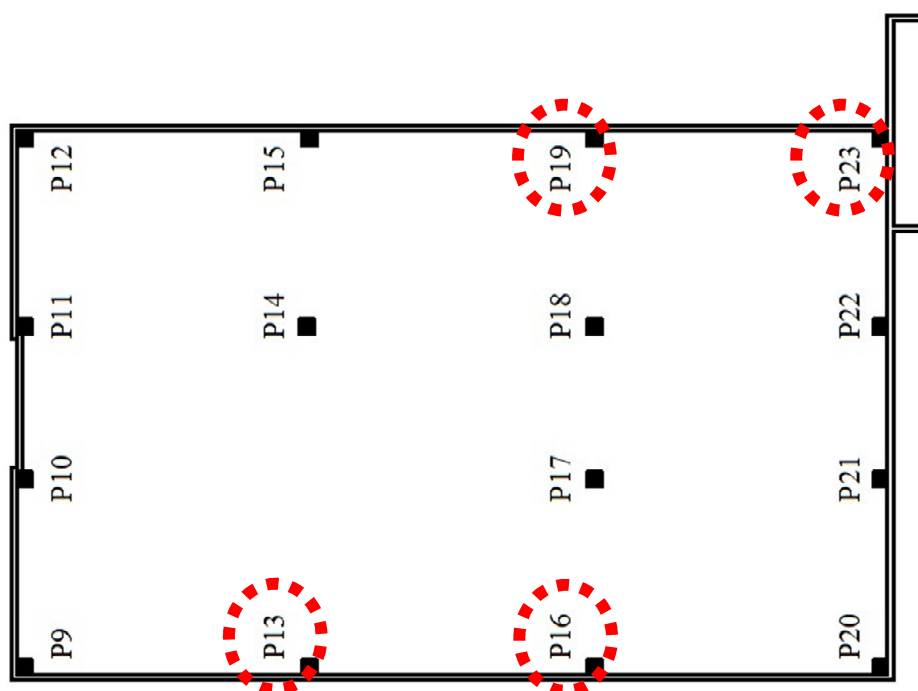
Schema planimetrico padiglione EXPO con evidenza pilastri non verificati
